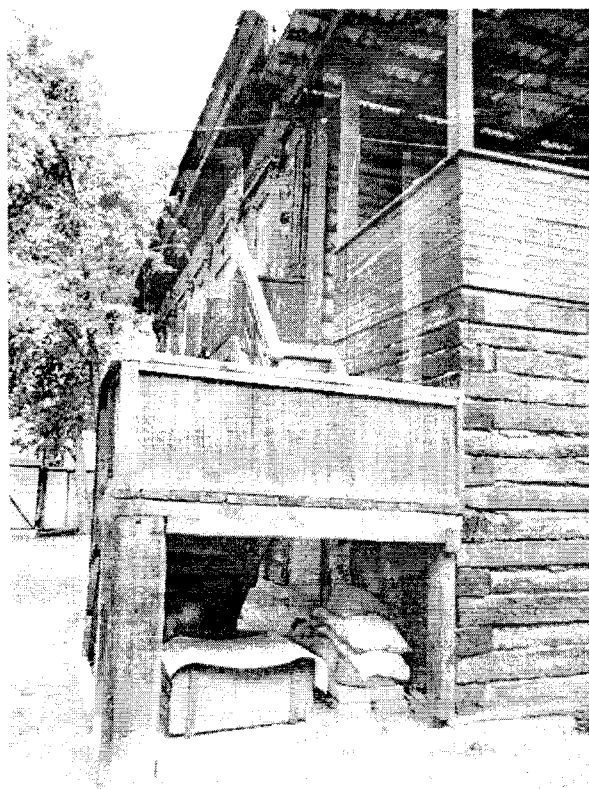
Торцевой юго-восточный фасад. Перестроенная открытая лестница на 2-ой этаж. Поздний пристрой к прируб туалета
